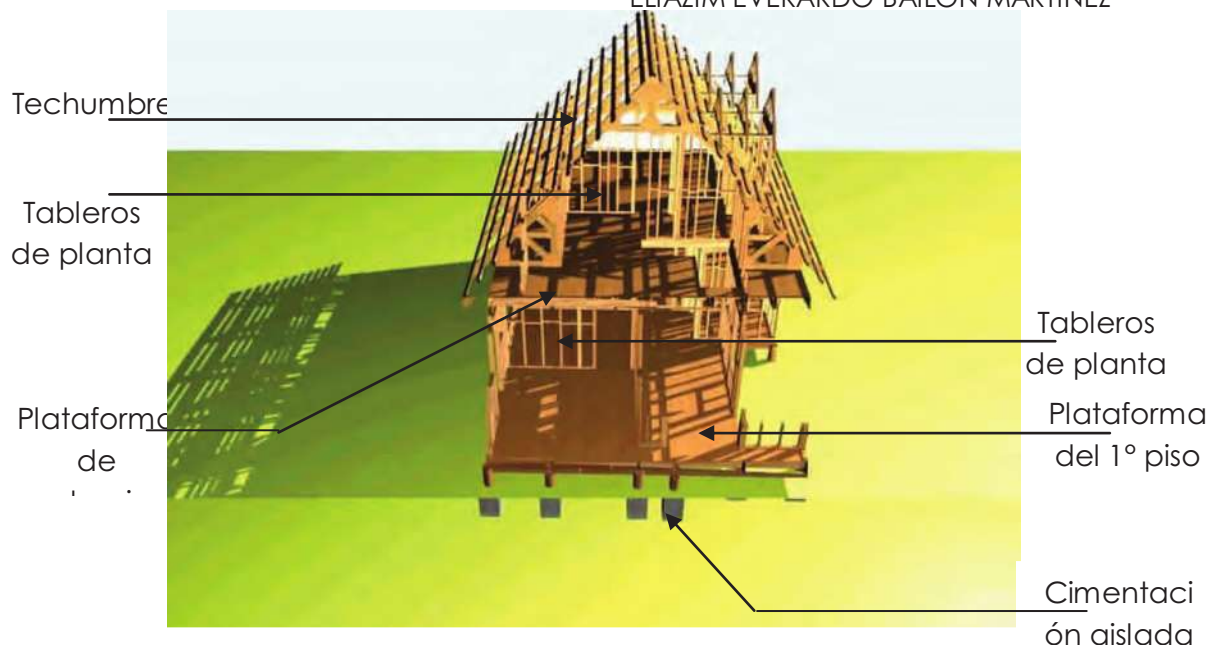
Corte de la vivienda especificando sus componentes estructurales principales. Fuente "La Construcción de Viviendas
